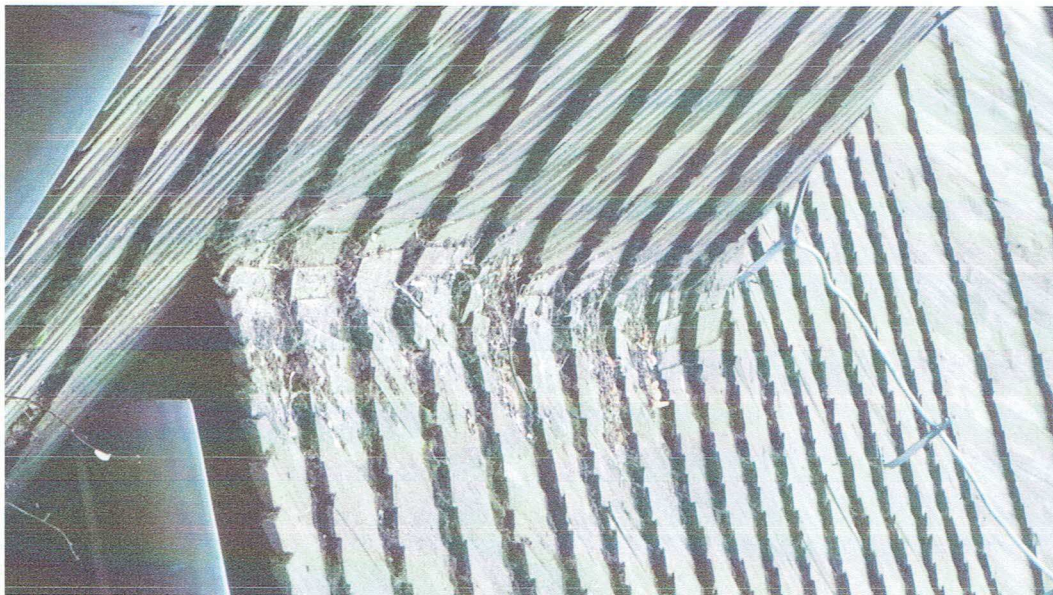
Korozja pokrycia dachu. Fot. autor.
